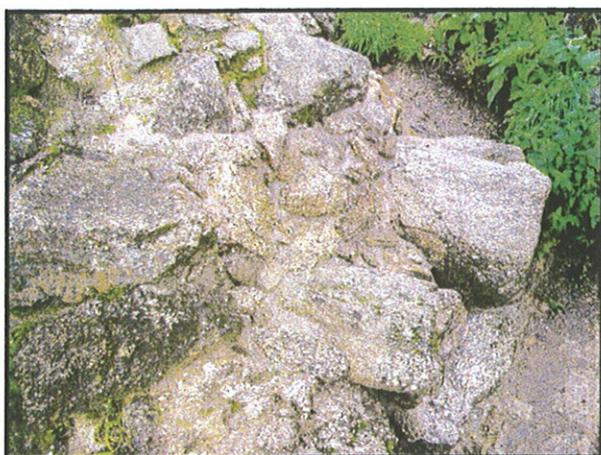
Detalle de argamasa y encinte en M1 al Norte.
